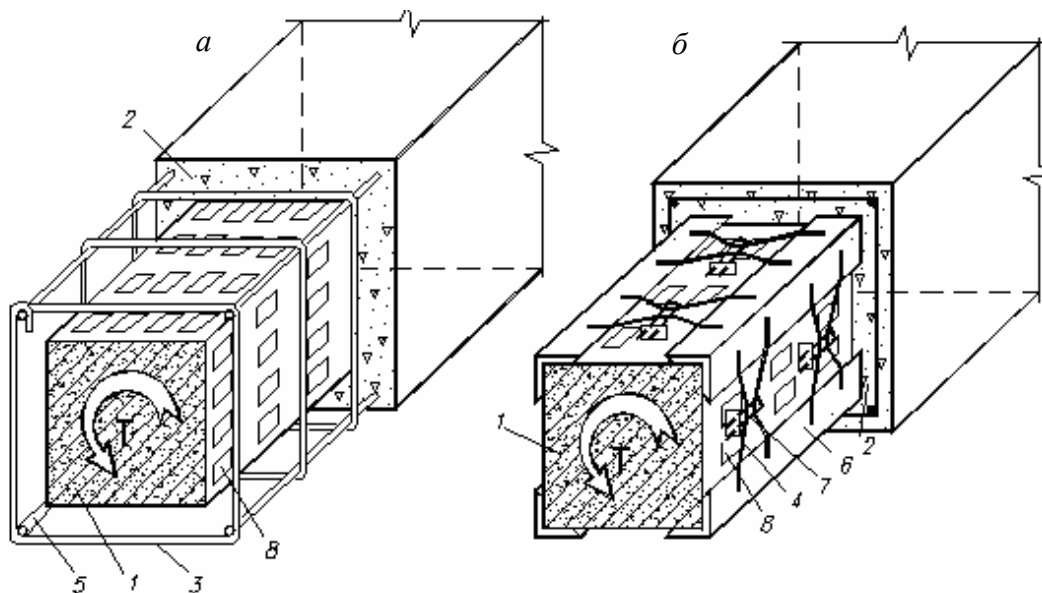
Усиление конструкций при кручении железобетонной облоймой: *а* – с поперечной арматурой без предварительного напряжения; *б* – с предварительно напряженной поперечной арматурой: 1 – усиливаемая конструкция, 2 – бетон облоймы, 3 – замкнутая поперечная арматура, 4 – предварительно напряженная поперечная арматура, 5 – продольная арматура облоймы, 6 – уголок, 7 – стяжной болт, 8 – насечка
